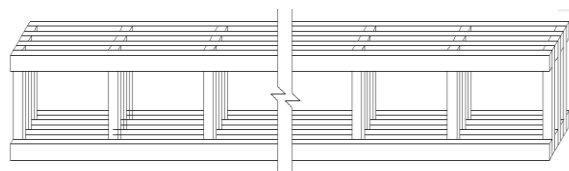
Безраскосная ферма покрытия из досок с клеевыми стыками
